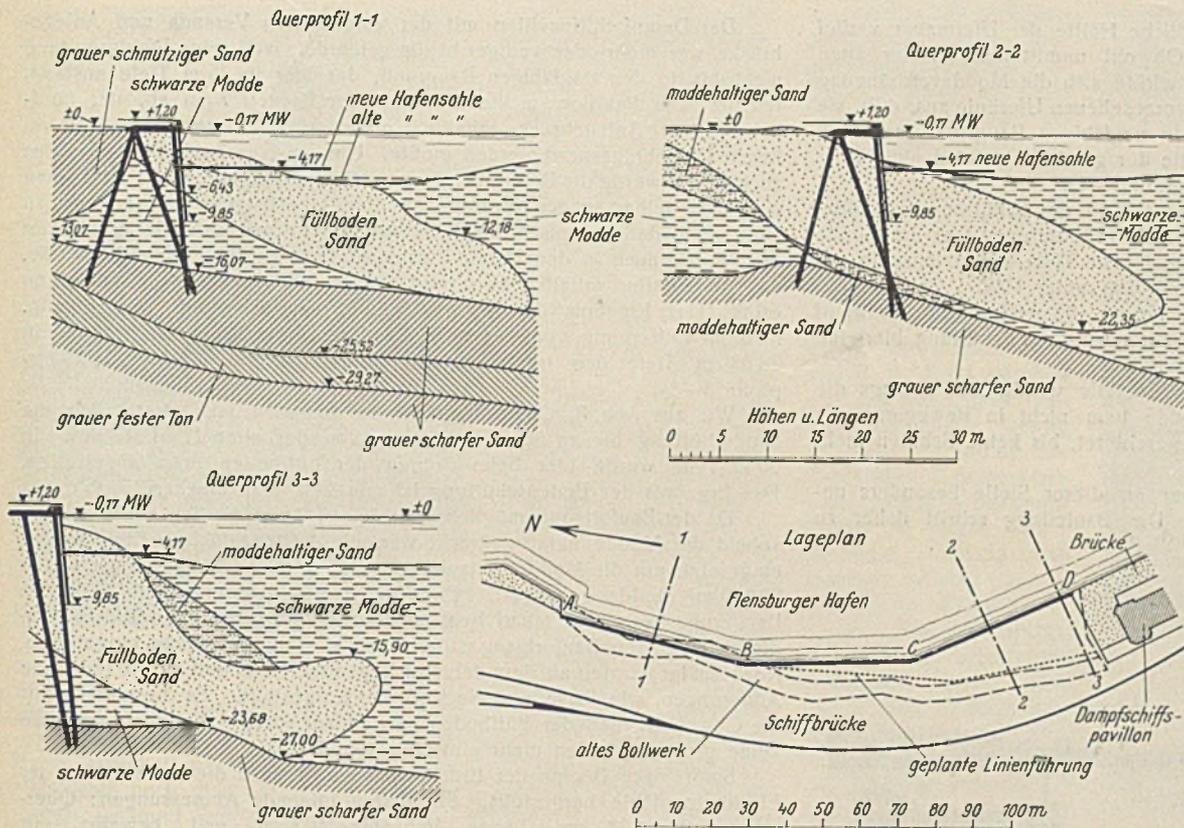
Lageplan und Querprofil nach der Sandschüttung.
